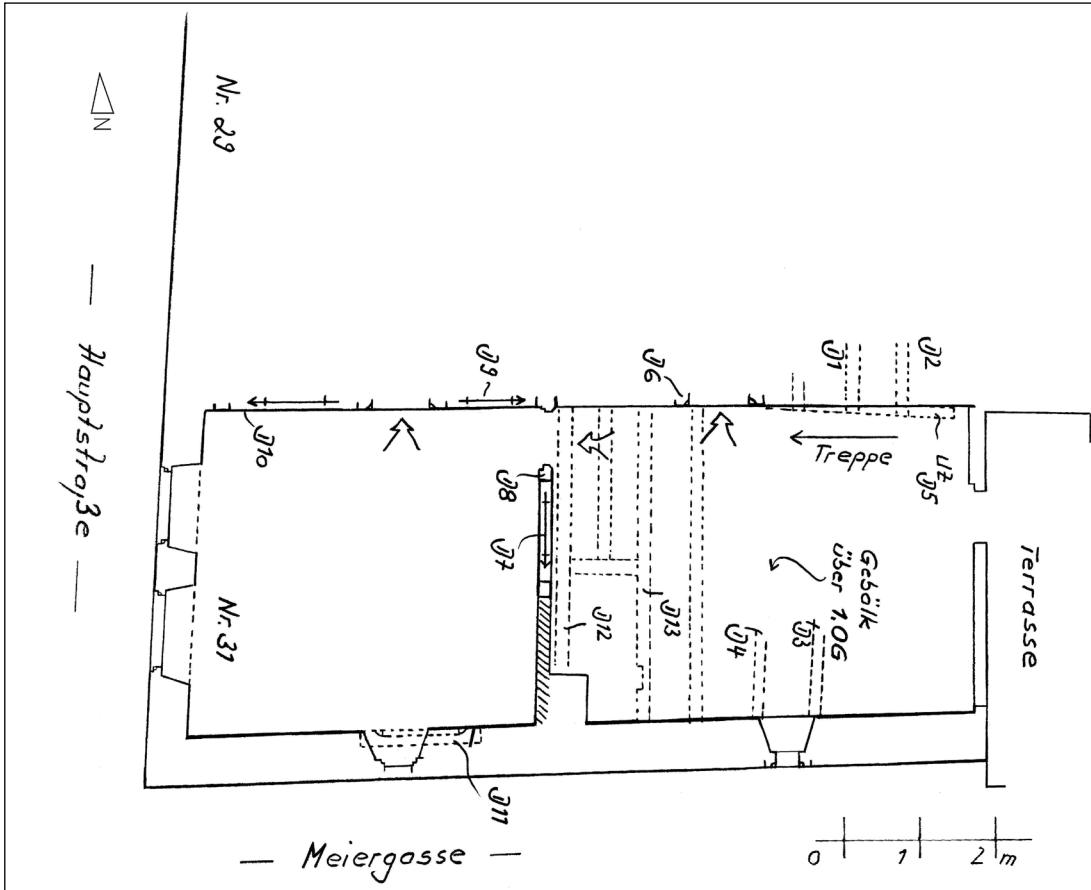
Hauptstraße 31, Grundriss 2. Obergeschoss mit Eintragung des Gebälks über dem 1. Obergeschoss.
